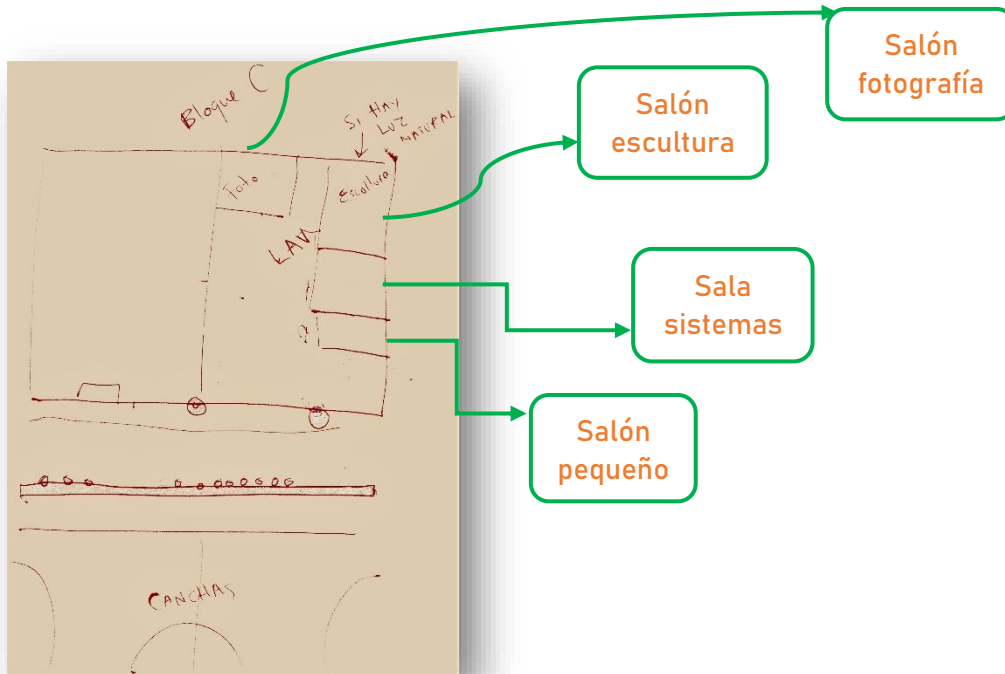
, plano primera planta de la LAV en la instalación de la 72 periodo 2012-2, Estudiante SJ.
